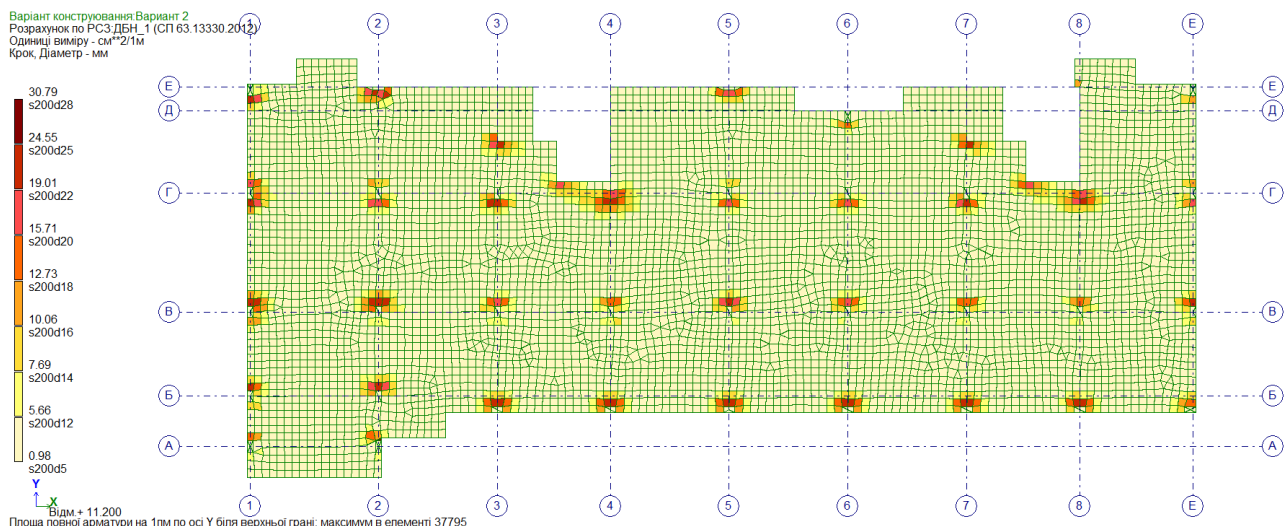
Ізополя розрахункового армування плити перекриття типового поверху. Верхня арматура вздовж осі Y
